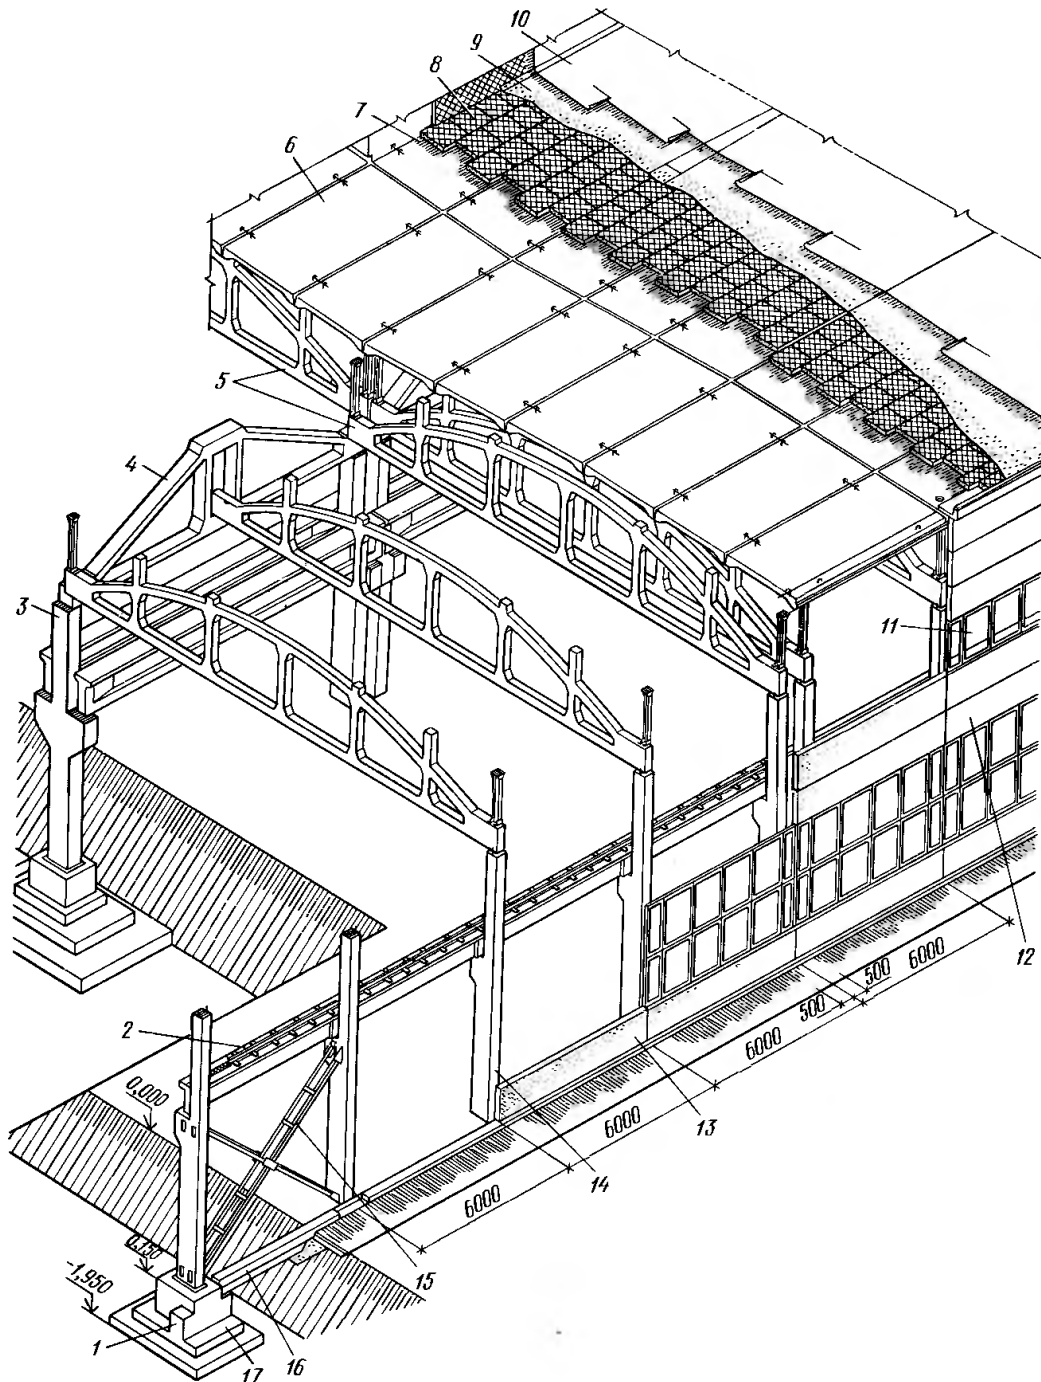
Конструктивне рішення одноповерхової багатопролітної виробничої будівлі: 1 – бетонний підлив для оперття фундаментних балок; 2 – підкранова балка; 3 – колона середнього ряду; 4 – підкроквяна залізобетонна ферма; 5 – безрозкісна залізобетонна ферма; 6 – плита покриття; 7 – пароізоляція; 8 – утеплювач; 9 – цементна стяжка; 10 – багат шаровий руберойдовий килим; 11 – засклення; 12 – стінова панель; 13 – цокольна панель; 14 – колона крайнього ряду; 15 – металевий хрестовий вертикальний зв’язок між колонами; 16 – фундаментна балка; 17 – фундамент
